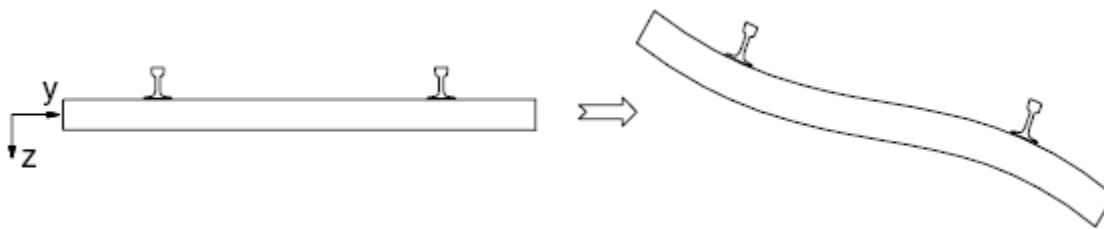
Deformada das travessas, corte transversal (Lim, N.H. [et al.], 2003)
